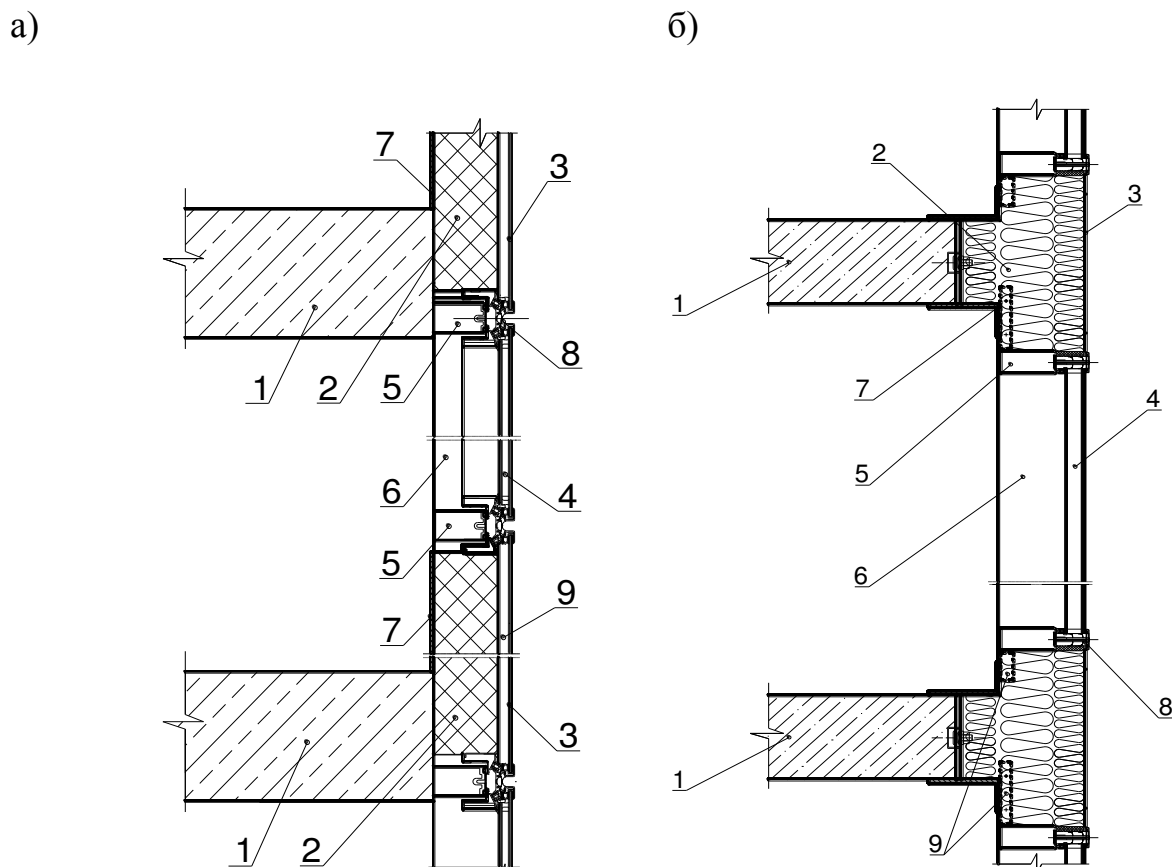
Конструктивна схема зовнішніх стін з комбінованим світлопрозорим фасадом (а) та з суцільним світлопрозорим фасадом з термоізоляцією плит перекриттів (б):
